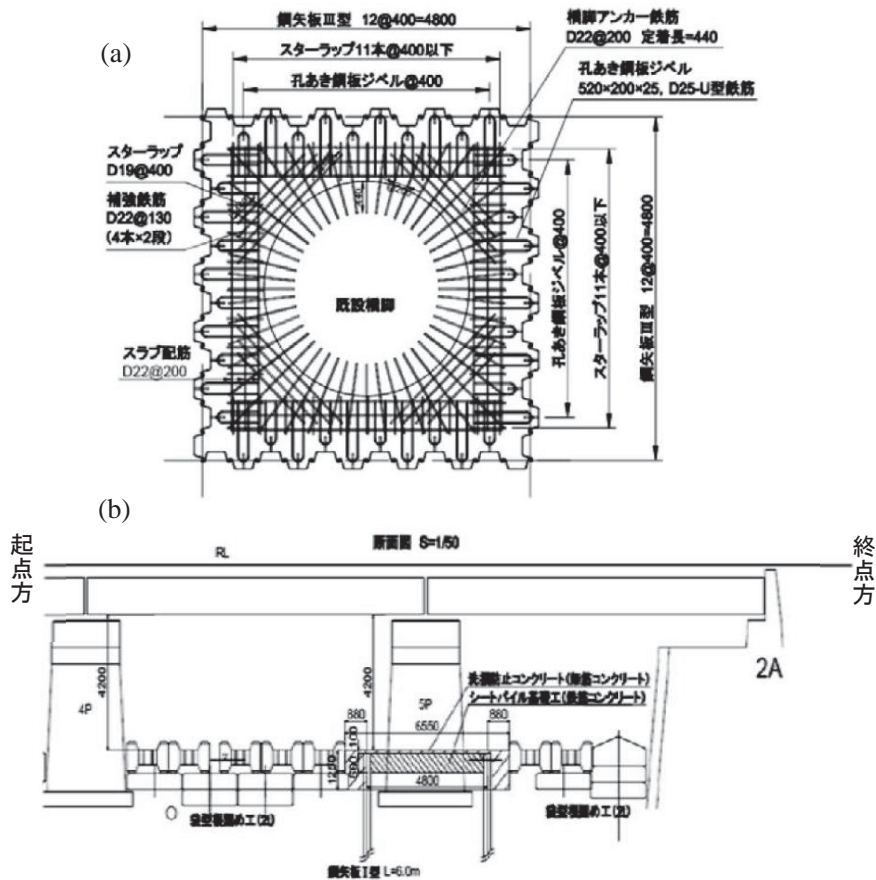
橋脚基礎の補強工事の概要<sup>33)</sup> : (a) 平面図、(b) 横断面図
